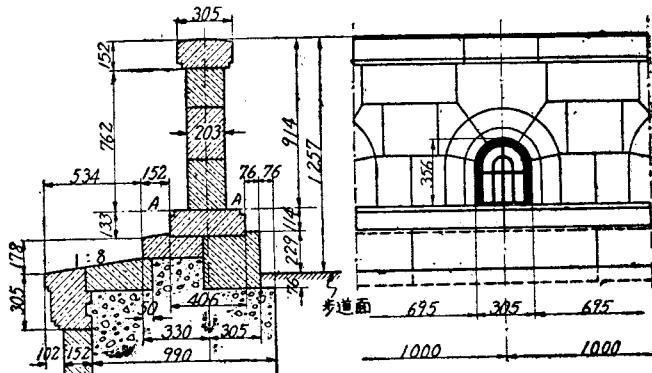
ホウライ橋の高ラン Fig.9 Railing of Horai br.
